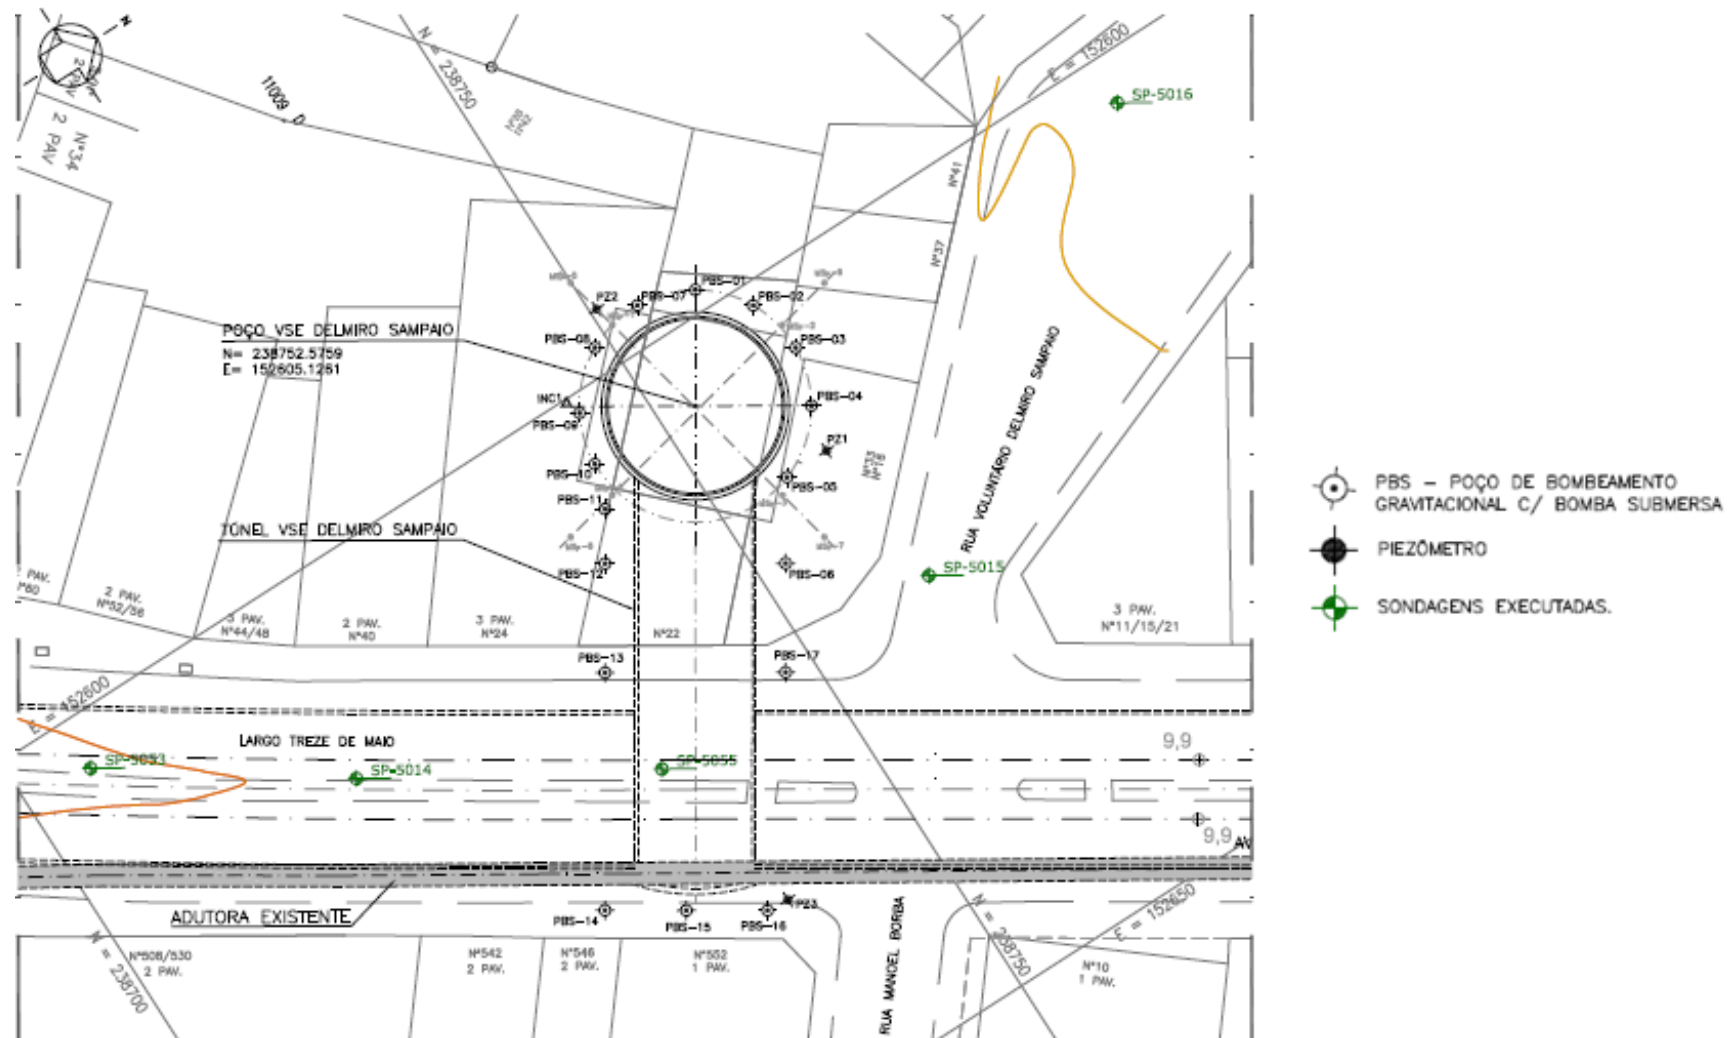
Planta do projeto de rebaixamento do Poço de Ventilação e Emergência (PVSE) Delmiro Sampaio.
